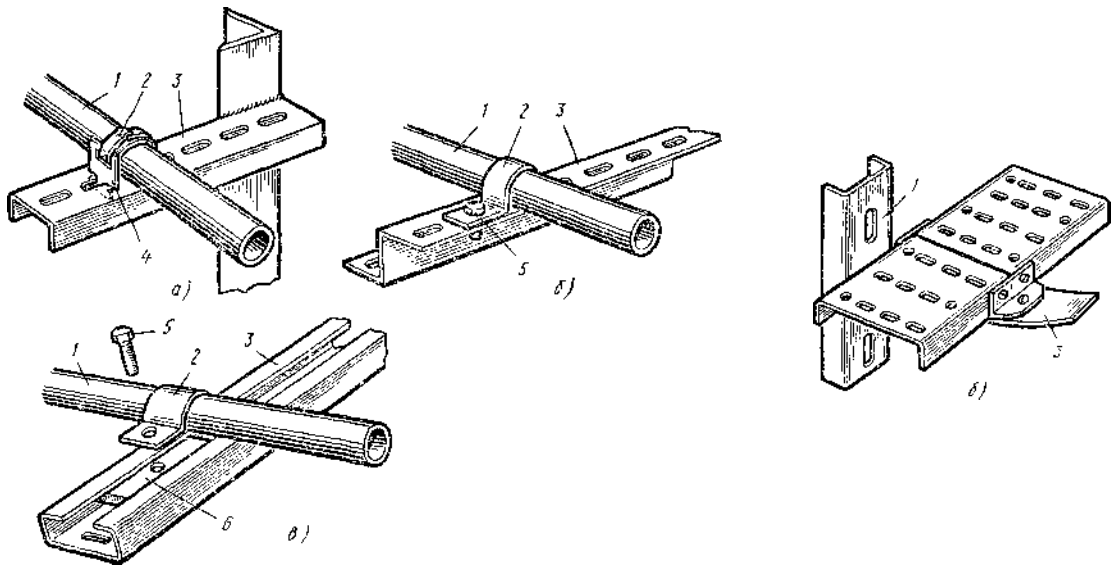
Перфоровані профілі і монтажні вироби для кріплення труб
